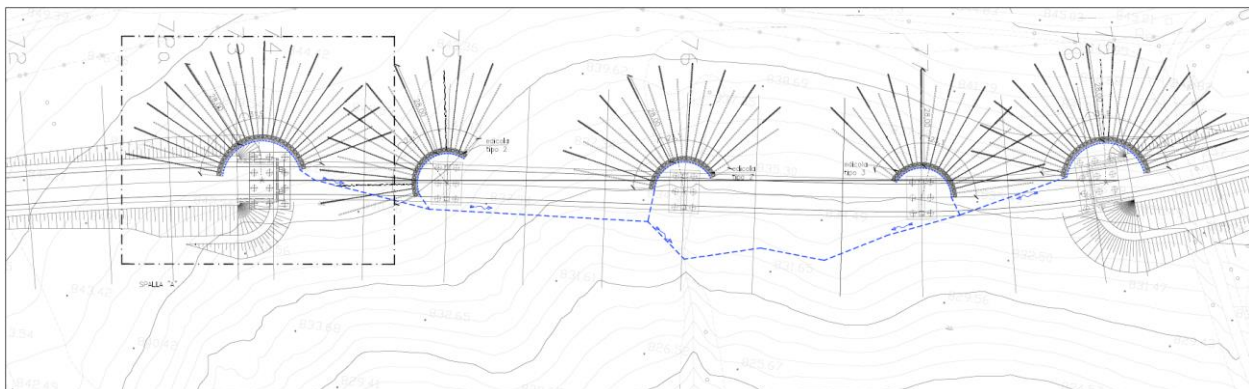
Planimetria di dettaglio del Viadotto 4
